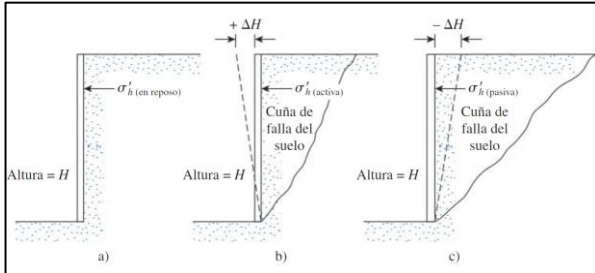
Empuje lateral de sobre los muros de retención. Fuente: (Das, 2016)
